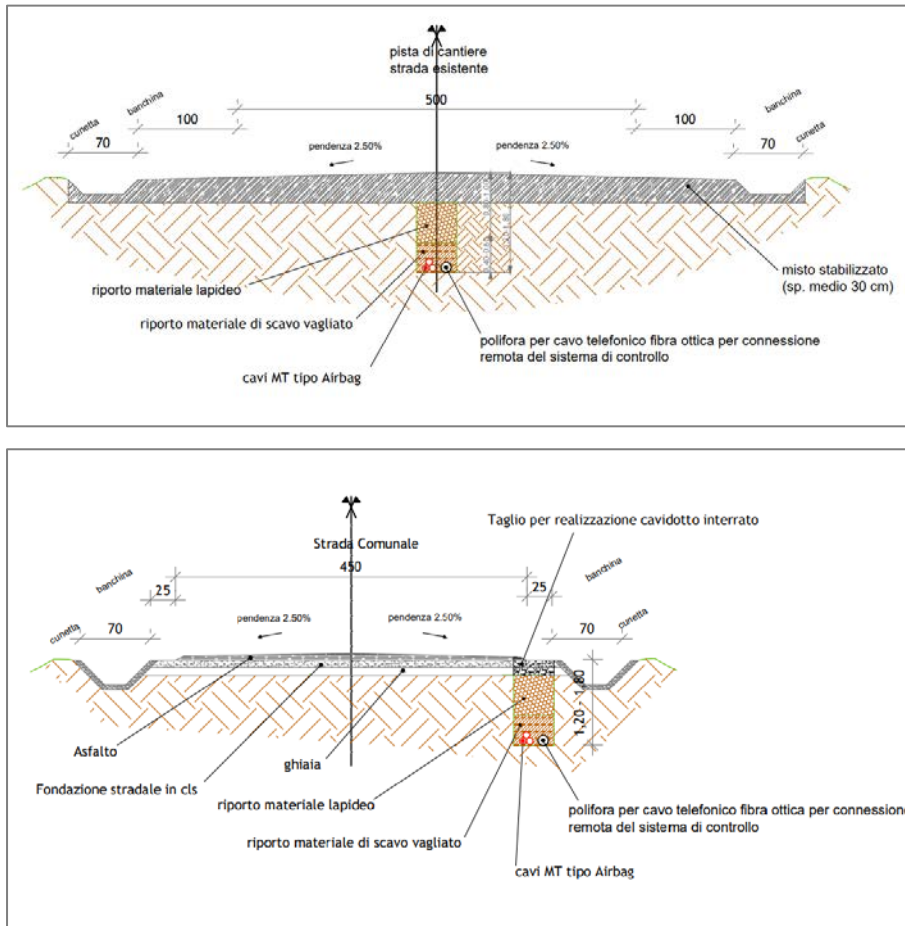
esempio di sezione tipo: Pista di cantiere con cavidotto interrato (in alto) e Passaggio di cavidotto su strada comunale esistente (in basso)
